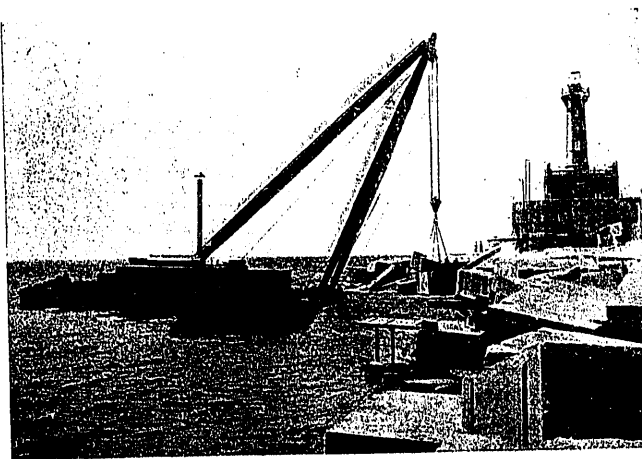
ª Colocación de bloques de 60 t, para el refuerzo exterior del morro del rompeolas de Levante.
